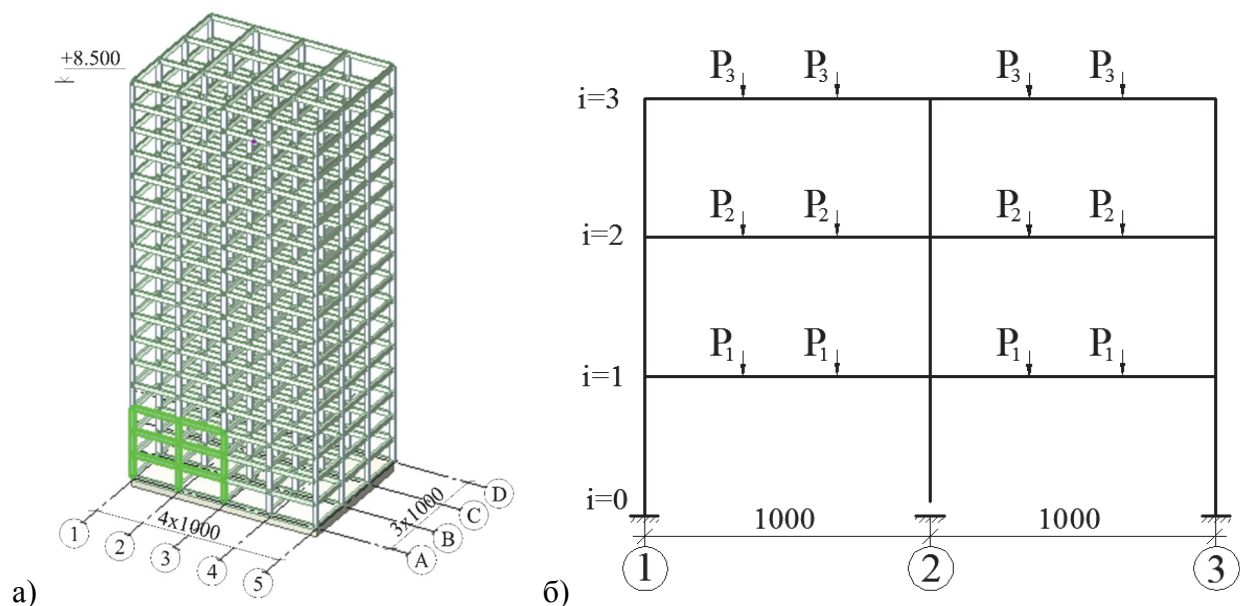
Схема модели конструктивной системы здания (а) и нагруженного фрагмента железобетонной рамы (б)
